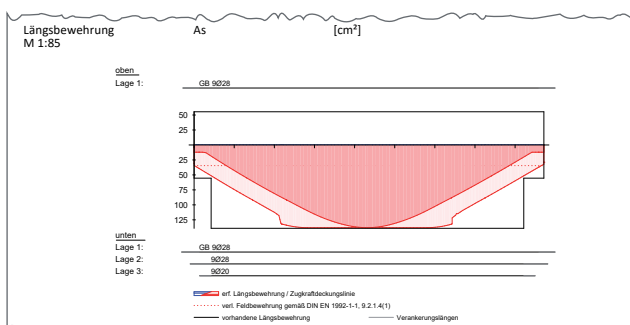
Bewehrungswahl Unterzug in der BauStatik
